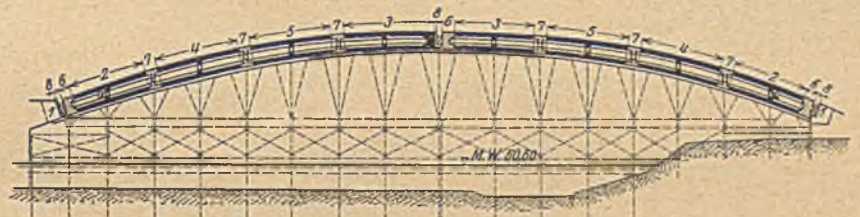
Entwurf Butzer-Spangenberg, Betonierungsvorgang der Hauptgewölbe.
